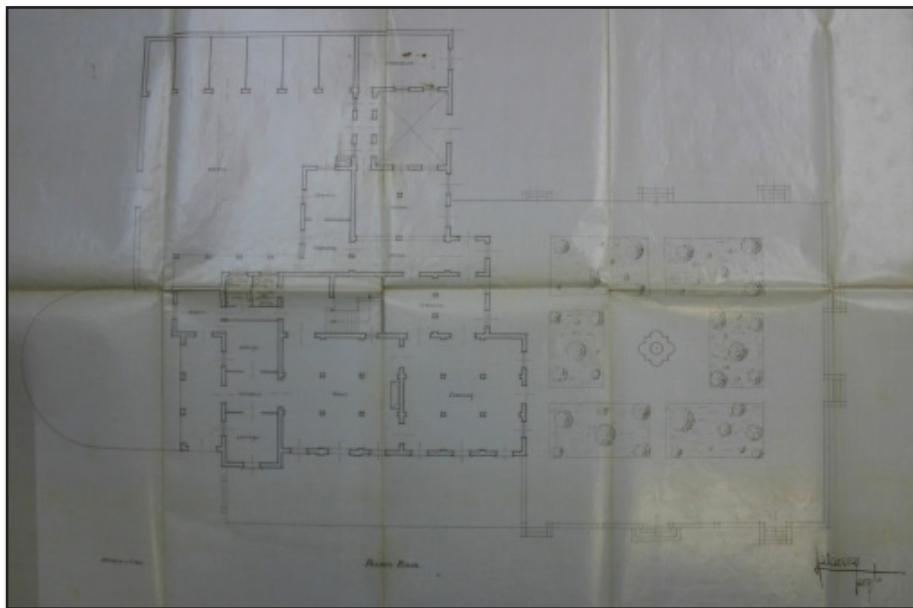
Hotel Oromana. Plano de la planta baja.
